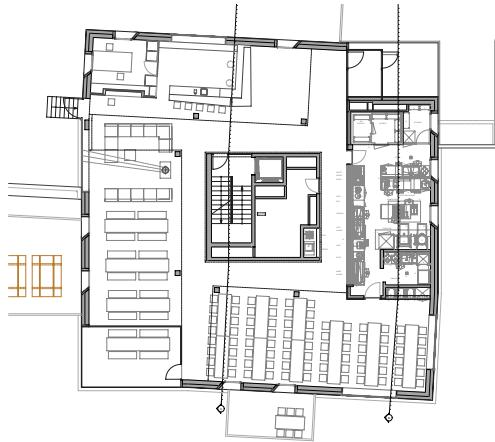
Grundriss EG Jugendherberge Scuol
